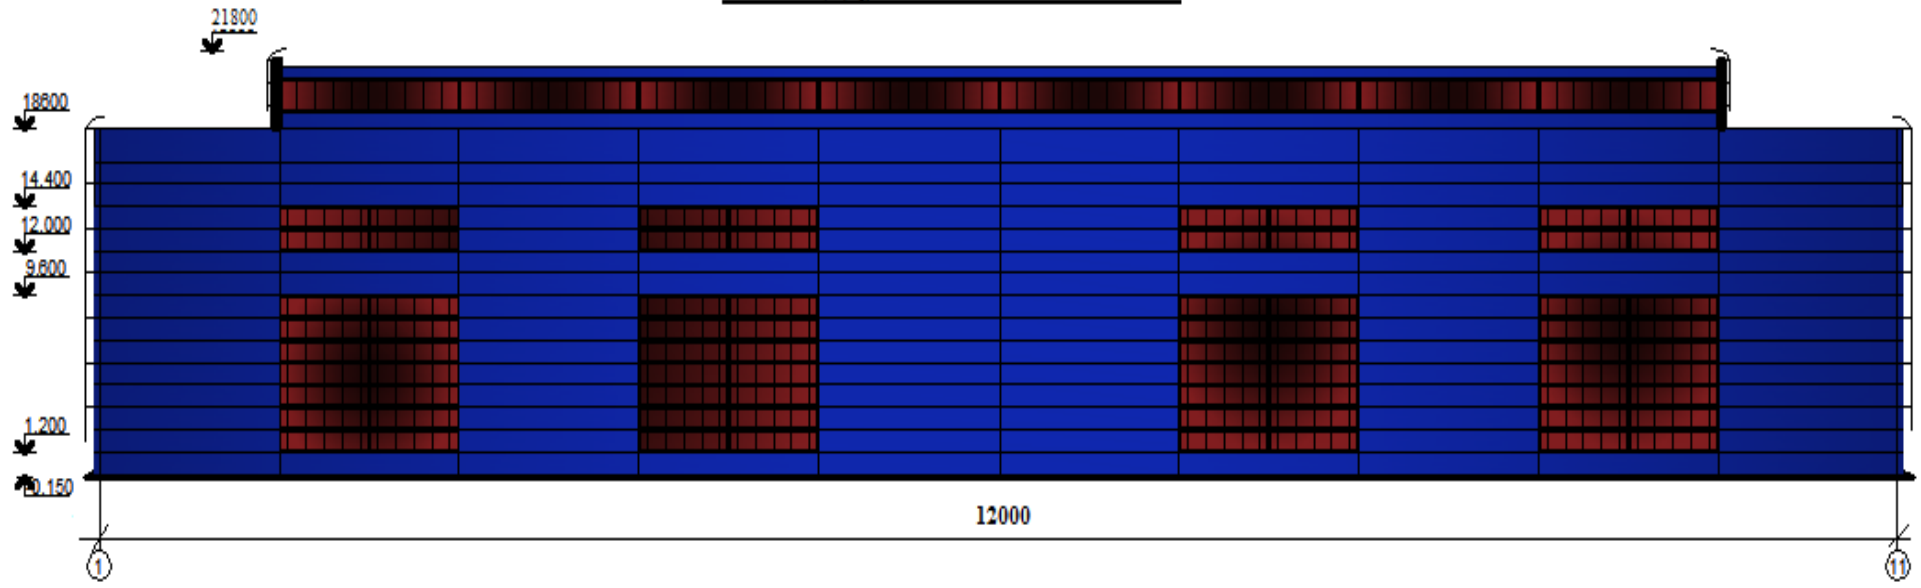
Фасад цеху у вісях 1 – 11
